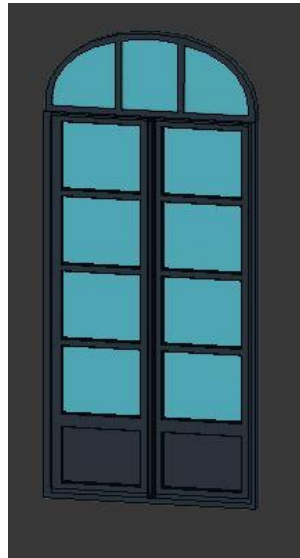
Fig. 45 - - Ventana frontal completa de la planta primera.
